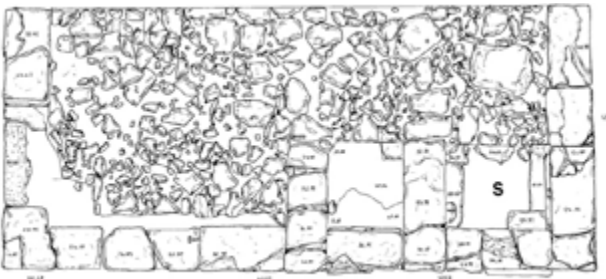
Planta de la torre I en el tramo 2 de la muralla. Véase los sillares a tizón. ATM.
